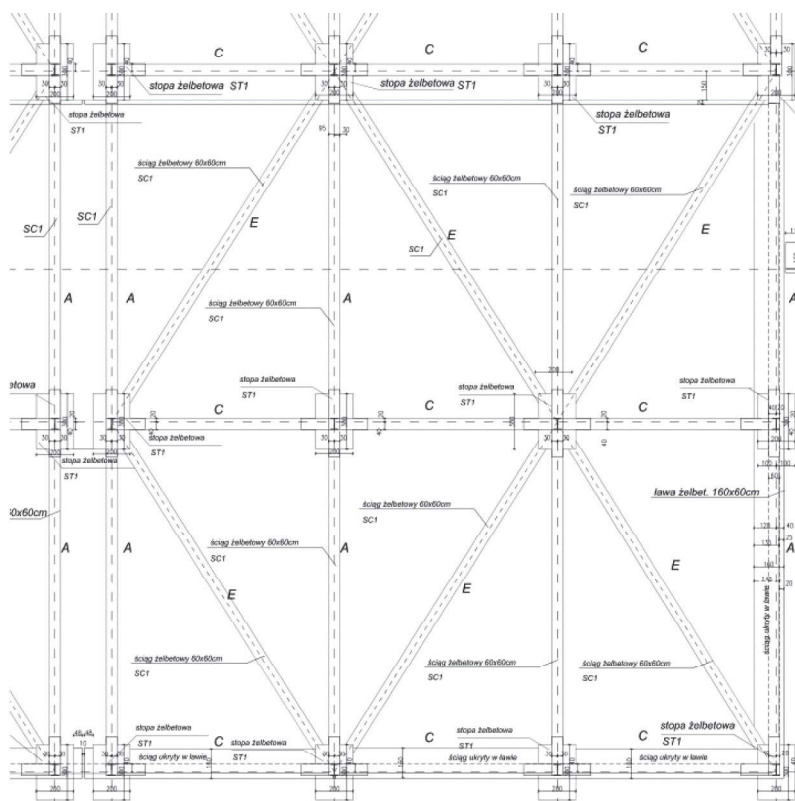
Rzut ław fundamentowych budynku (Archiwalne ...)
